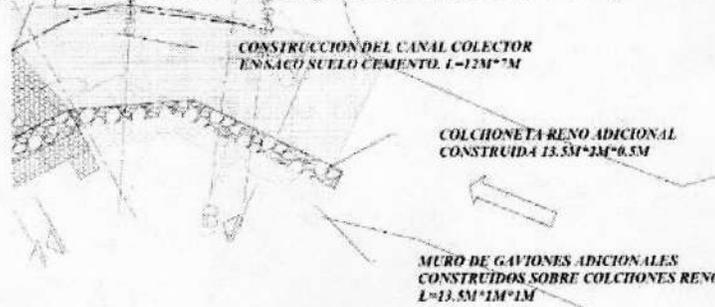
Esquema en planta de colchoneta reno y muro en gavión de un nivel en margen izquierda de quebrada La Morrocuya
